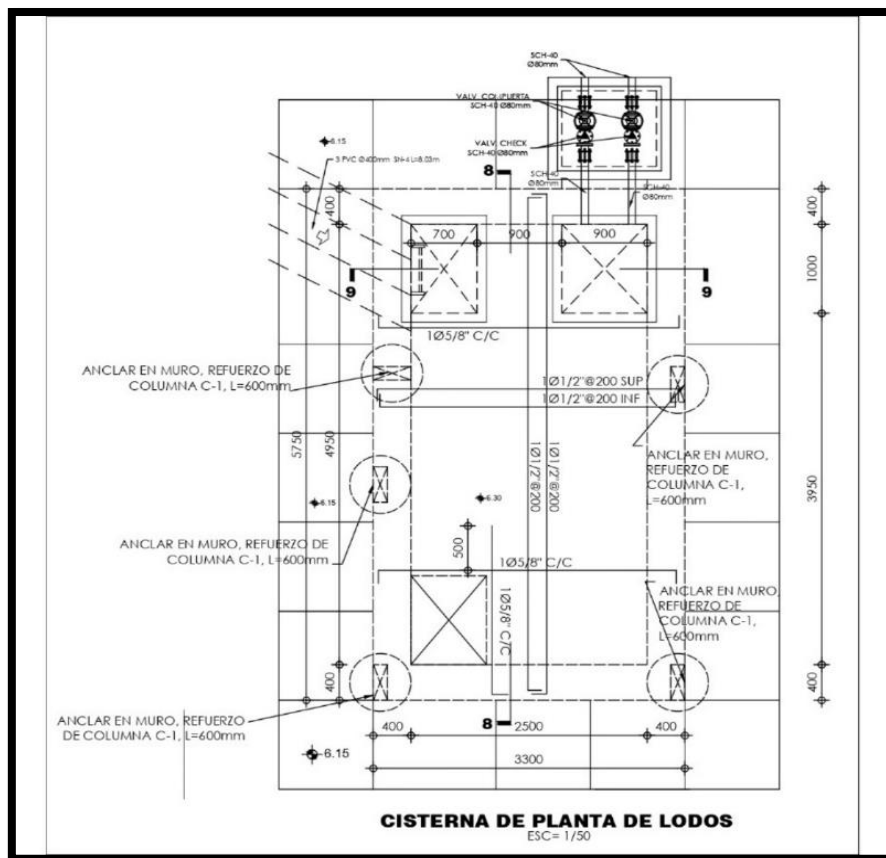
Plano de planta - cisterna de la planta de lodos
